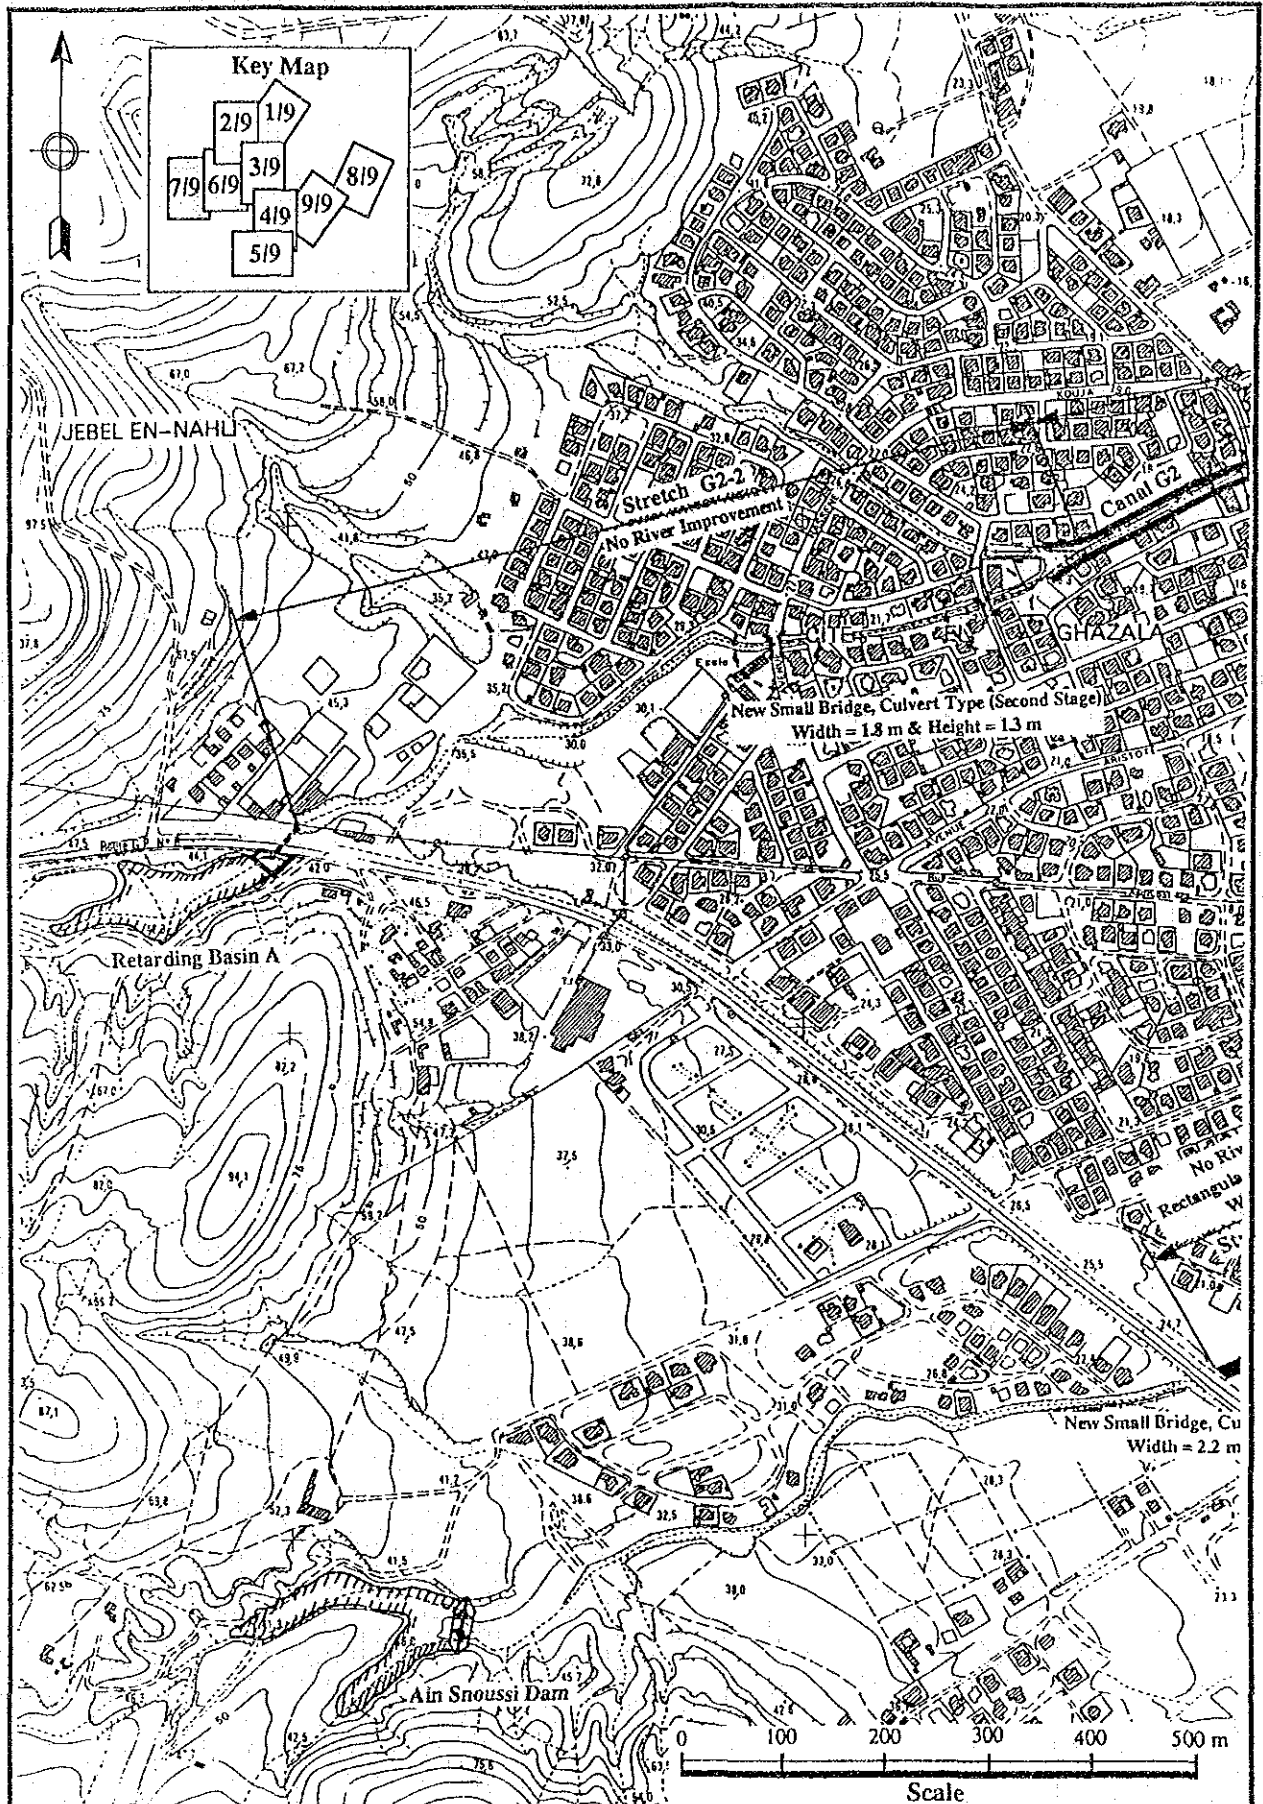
Tracé en plan de la variante d'aménagement de l'Oued Enkhilet (7/9)
